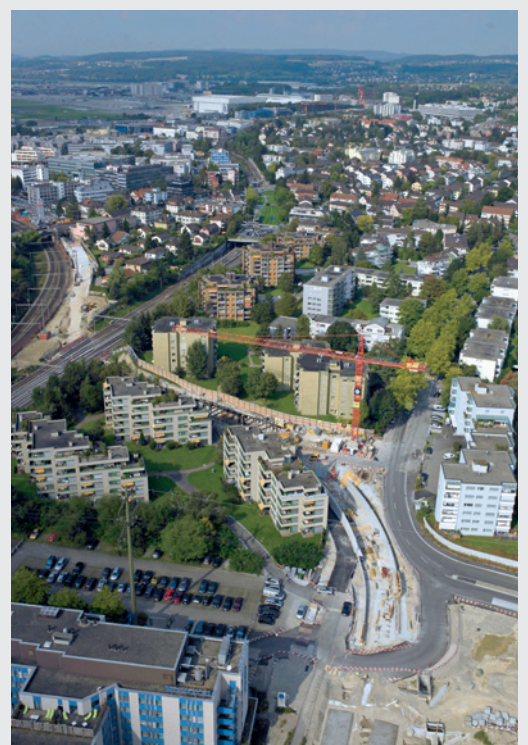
Vertikale Entflechtung – Bau des Margarethentunnels
